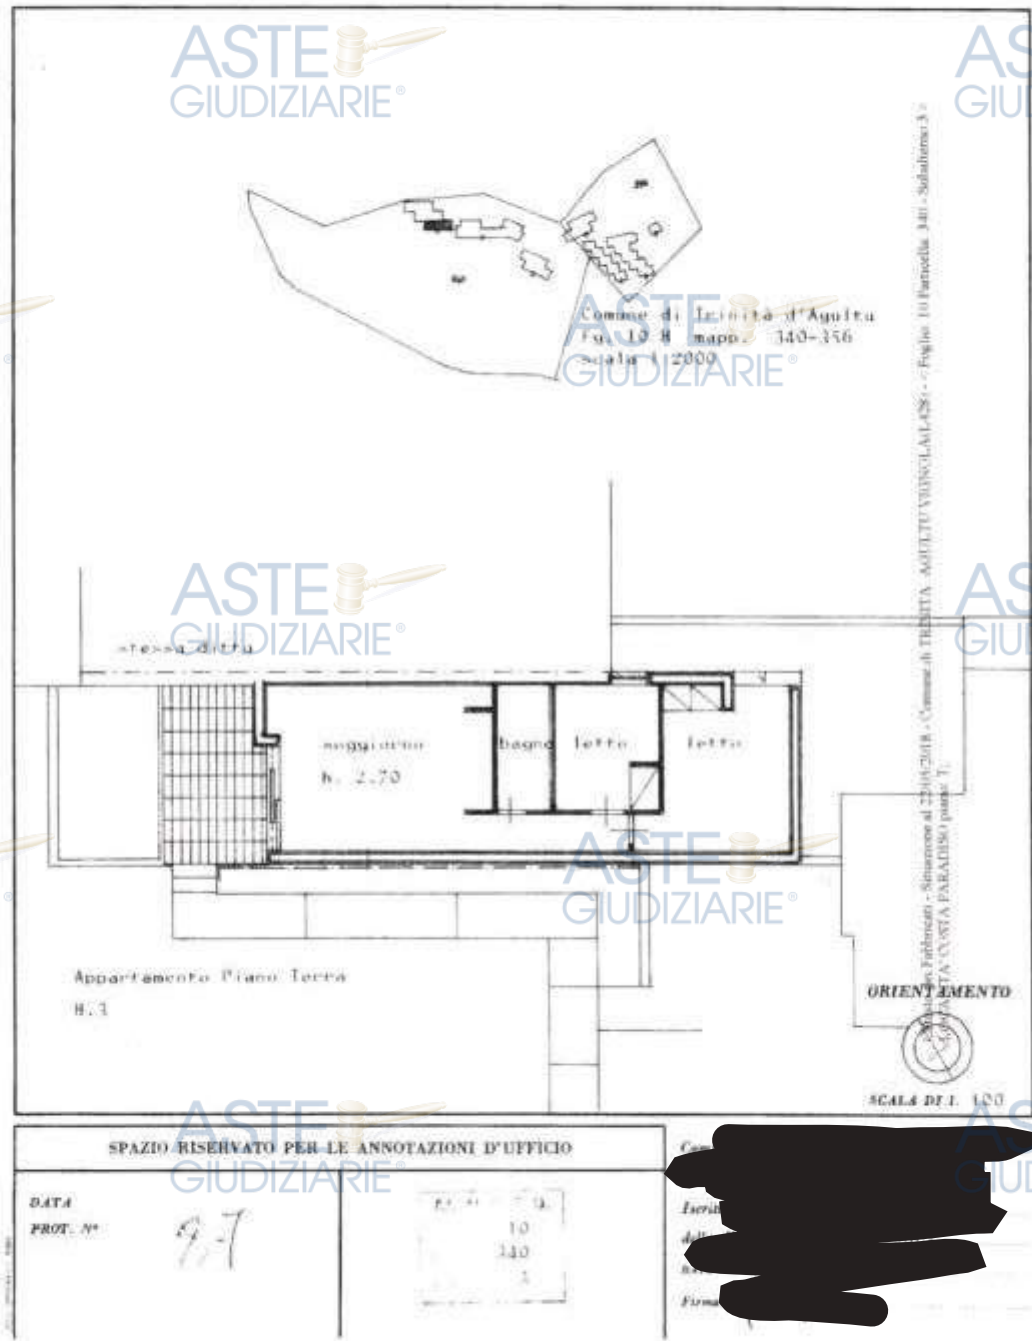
Visura planimetrica catastale originaria Fig. 10 Part. 340 Sub 3
